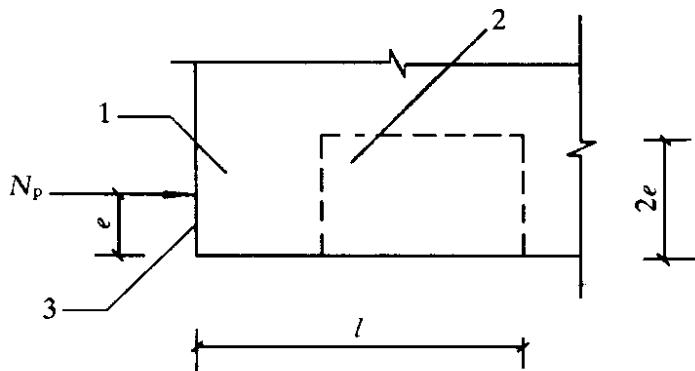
防止沿孔道劈裂的配筋范围
